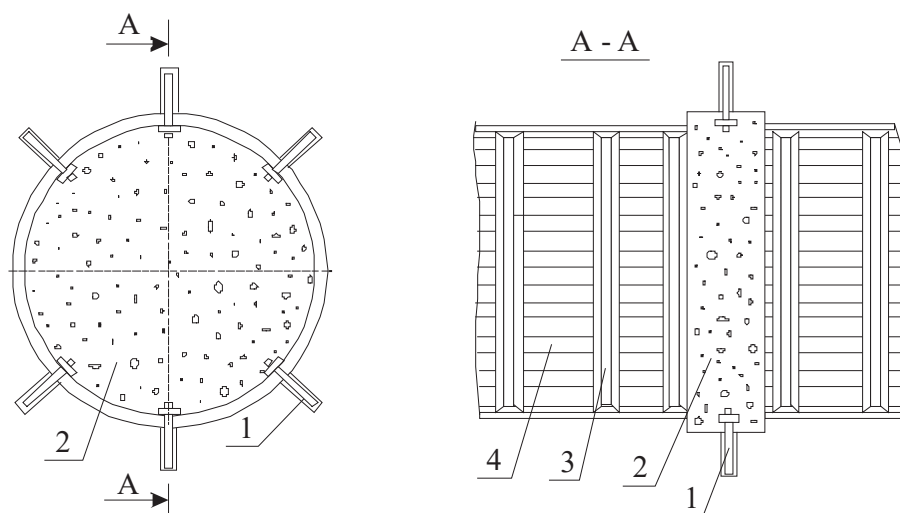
Схема бетонной шахтной перемычки в горной выработке: 1 — анкерные болты, 2 — перемычка, 3 — металлическая крепь из спецпрофиля, 4 — затяжки
